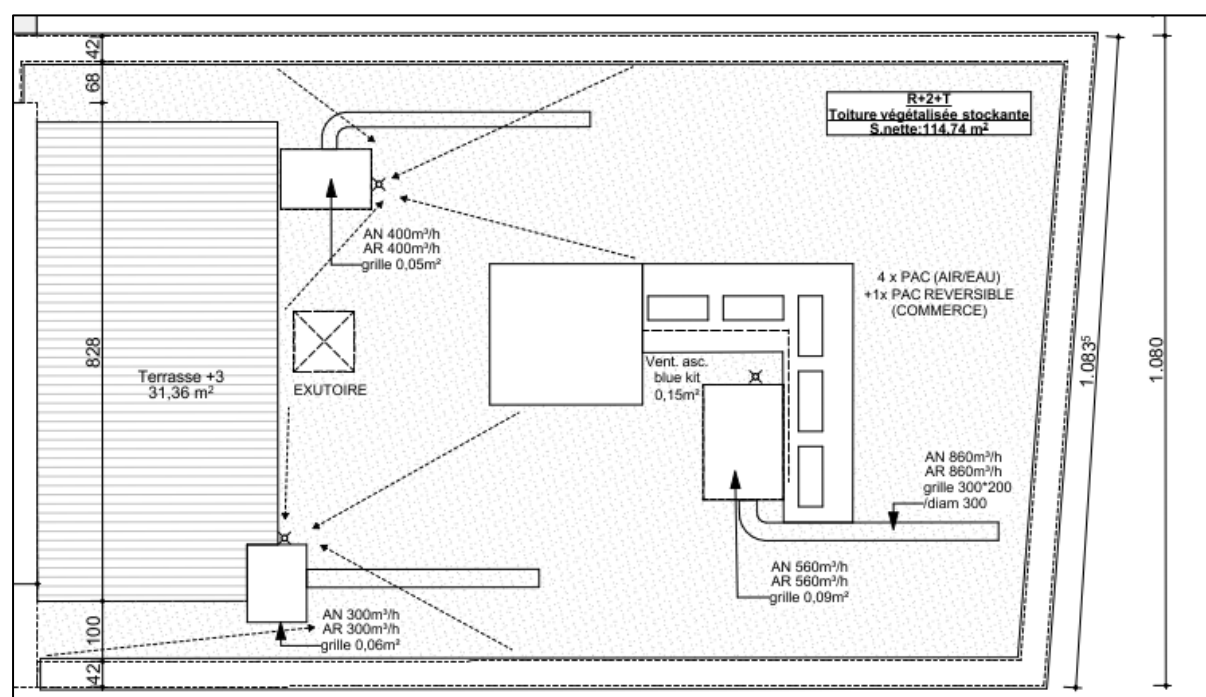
Plan de toiture du bâtiment 1 – étage 3 (source : Plans PU)
